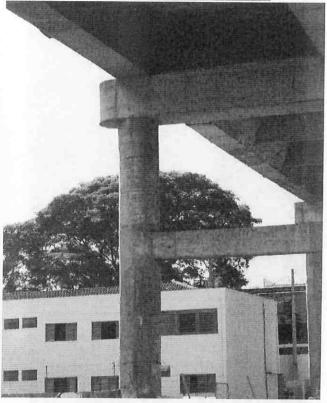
Vista de pilares com pequenas fissuras, pontos de desplacamento de concreto e eflorescência.
